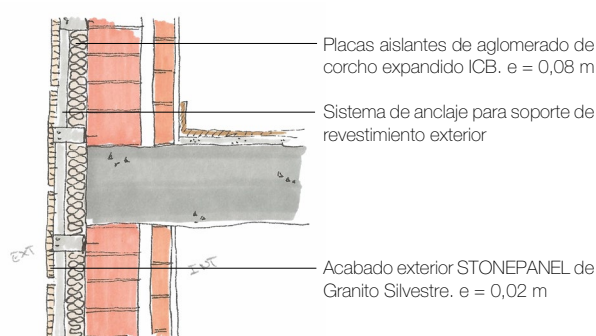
Sistema de fachada ventilada. Encuentro pared de fachada con forjado (autoría propia).
